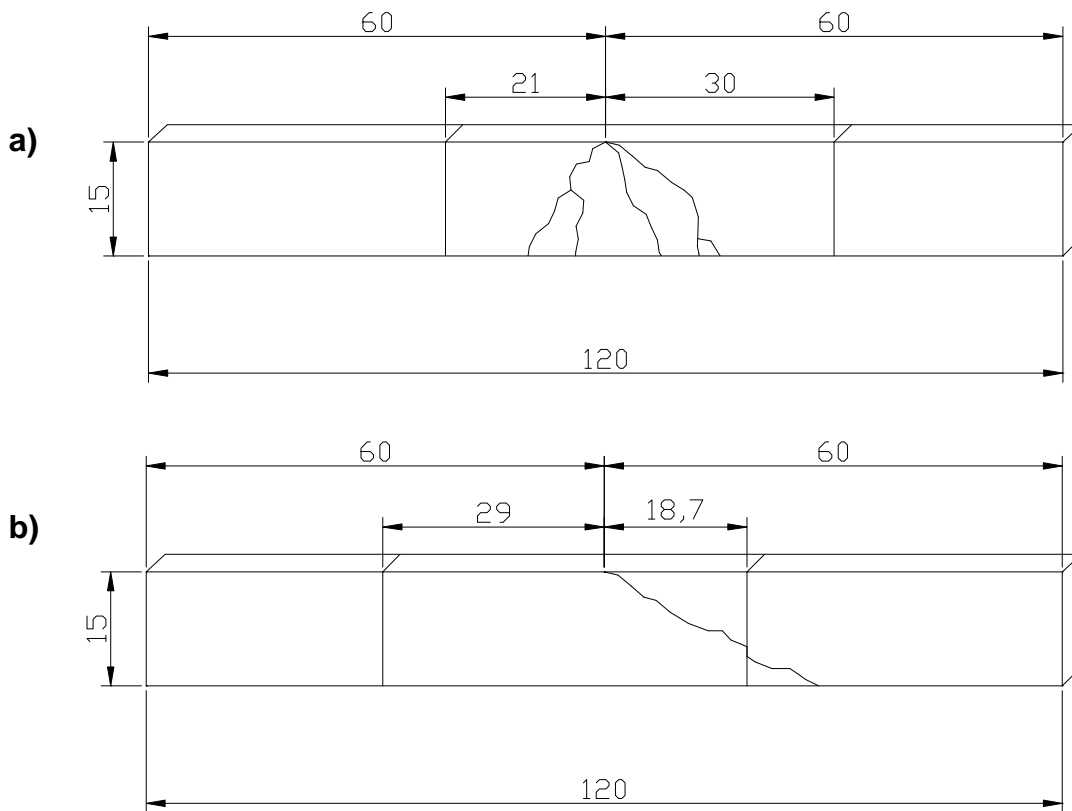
Esquema de fisuración de vigas después de la aplicación de carga mecánica. a) viga 10 b) viga 16
